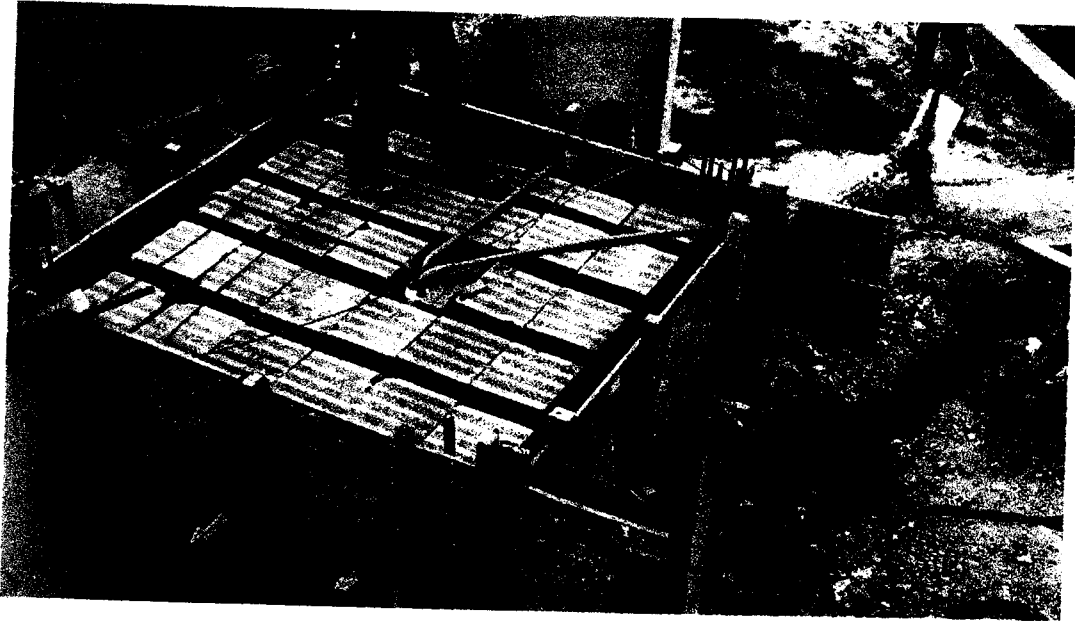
Losa aligerada de cuarto de pesaje.
